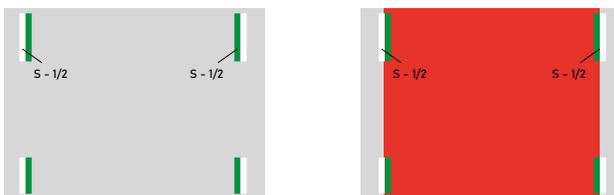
Prinzipskizze der Markierungsvarianten einer Fahrradstraße auf einer Radvorrangroute (Achtung: weiße Schmalstrichmarkierung derzeit noch nicht StVO-konform!)
